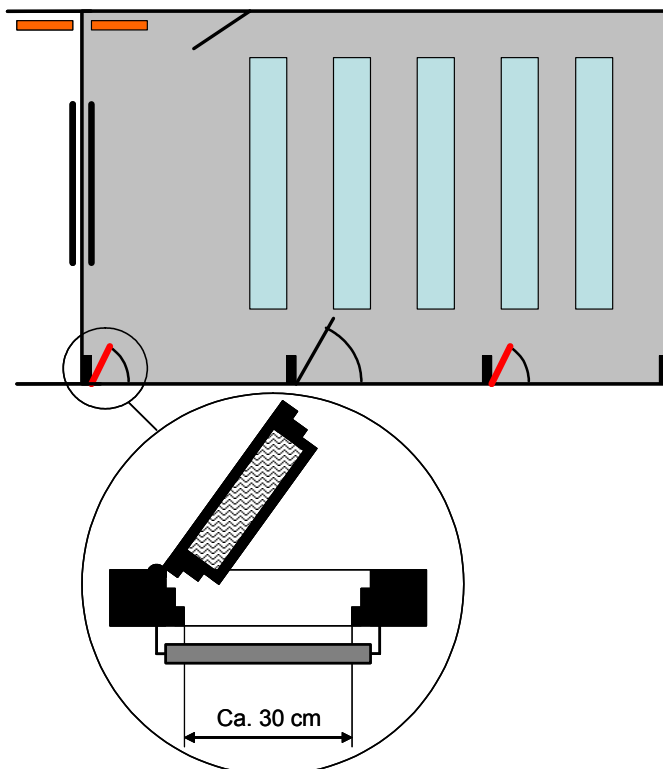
Schematischer Grundriss eines Unterrichtszimmers und Vergrösserung des Lüftungsflügels mit Wetterchutzlamellen davor
